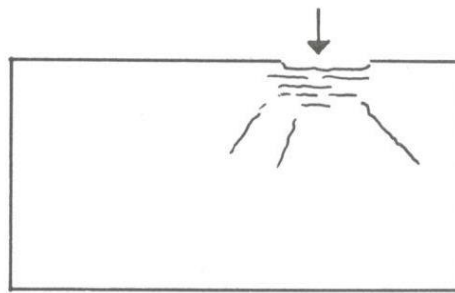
Ruptura localizada da alvenaria sob o ponto de aplicação da carga e propagação de fissuras a partir desse ponto.
